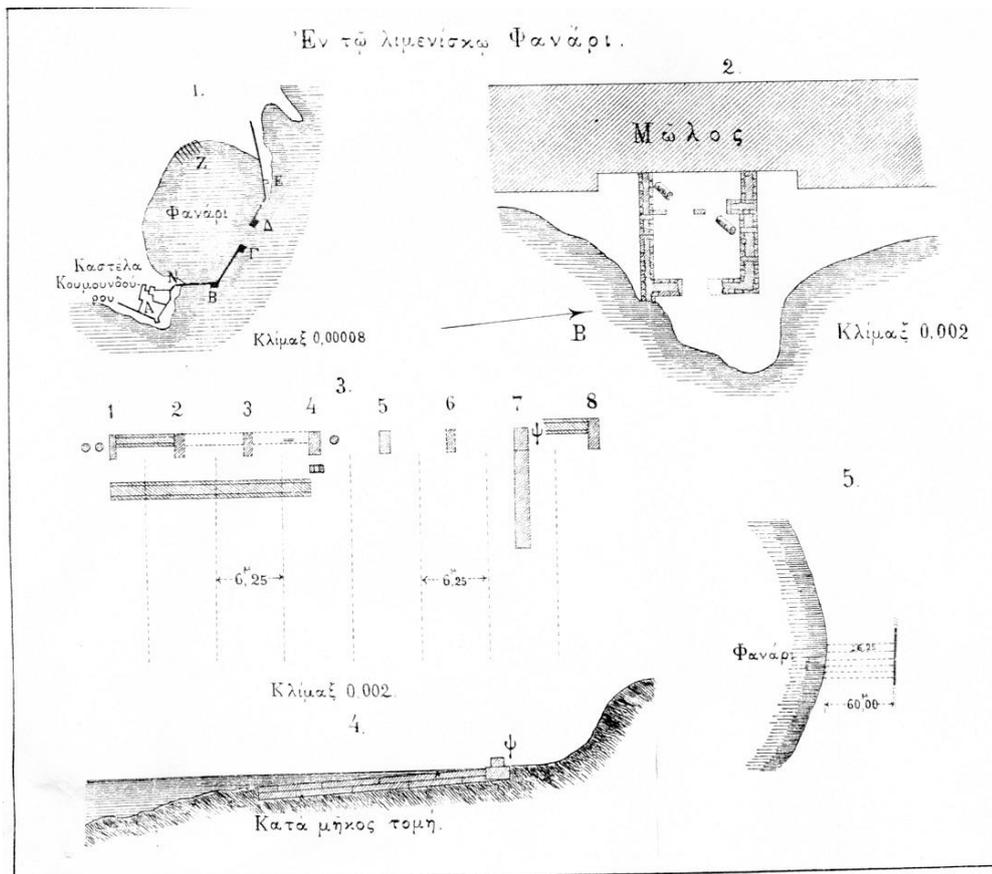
Dibujo de las estructuras encontradas en la cuenca de Mouniquia (Fanari) tal y como aparecían a finales del siglo XIX. Plan del puerto, plan del muelle occidental, plan de la sección longitudinal de los hangares y plan de las fortificaciones. Agelopoulos, H. (1898), tabla A.
